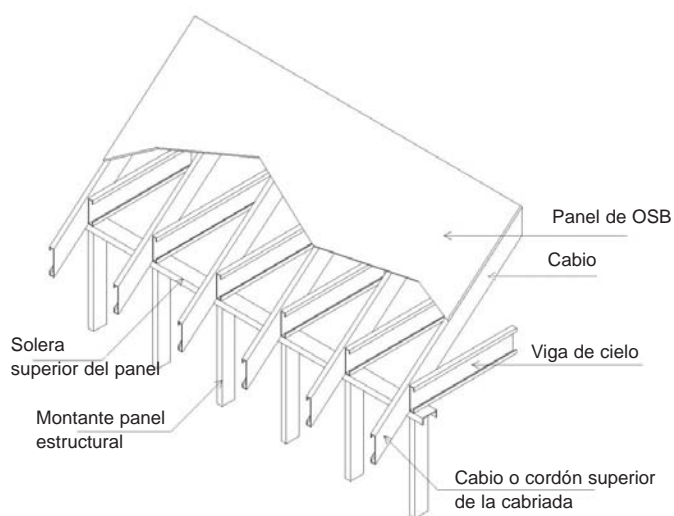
Cabios y vigas alineados con los montantes del panel estructural.
